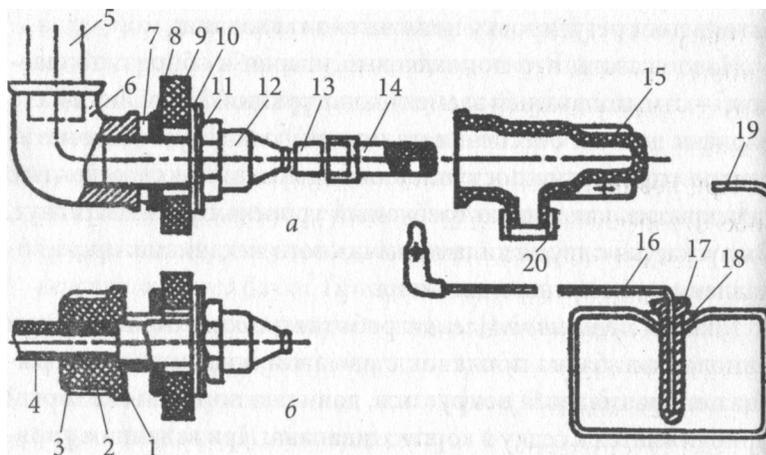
Конструкция горизонтального поплавок-пластмассового клапана: *а* — пластмассовый с жесткой подводкой; *б* — пластмассовый с гибкой подводкой: 1 — прокладка резиновая; 2 — пластмассовая накидная гайка; 3 — прядь уплотнения; 4 — трубка пластмассовая; 5 — труба подводки с Ду = 15 мм; 6 — угольник; 7 — прядь уплотнения; 8 — контргайка пластмассовая; 9 — корпус смывного бачка; 10 — прокладка резиновая; 11 — шайба пластмассовая; 12 — корпус клапана; 13 — прокладка (пробка); 14 — шток; 15 — втулка; 16 — рычаг стальной; 17 — чулок; 18 — поплавок; 19 — ось латунная; 20 — резиновая трубка
